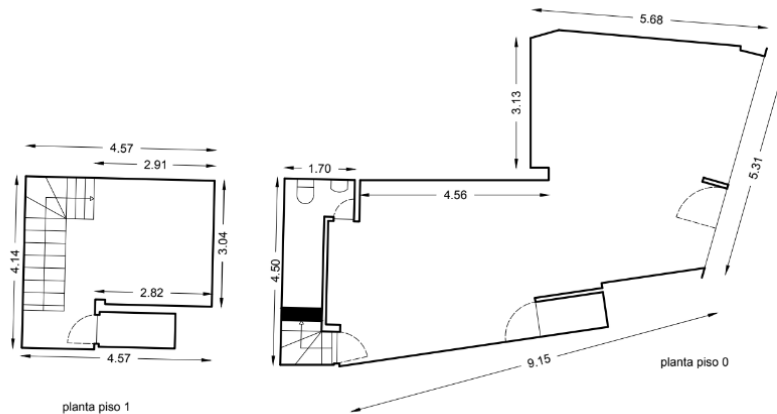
Planta baixa do Espaço Há Baixa, na Baixa de Coimbra.
